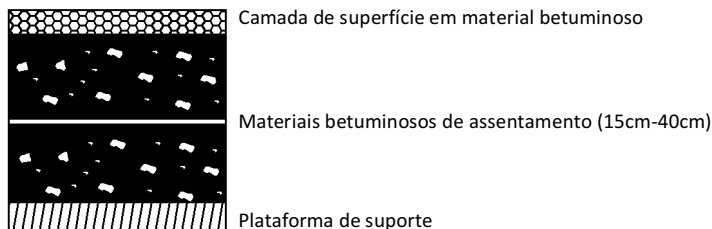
Estrutura de pavimento tipo *chaussée bituminouses épaissés* (LCPC/SETRA, 1994).
